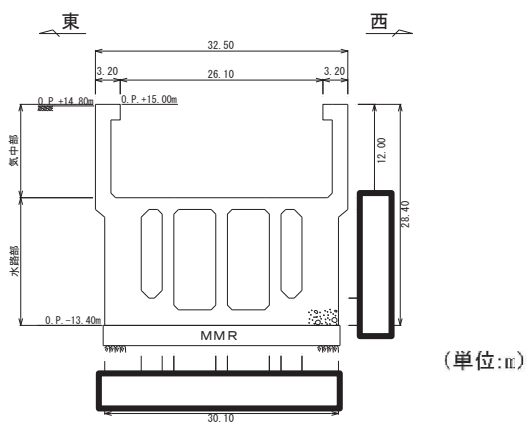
海水ポンプ室断面図 (B-B 断面, 東西 (補機ポンプエリア))
